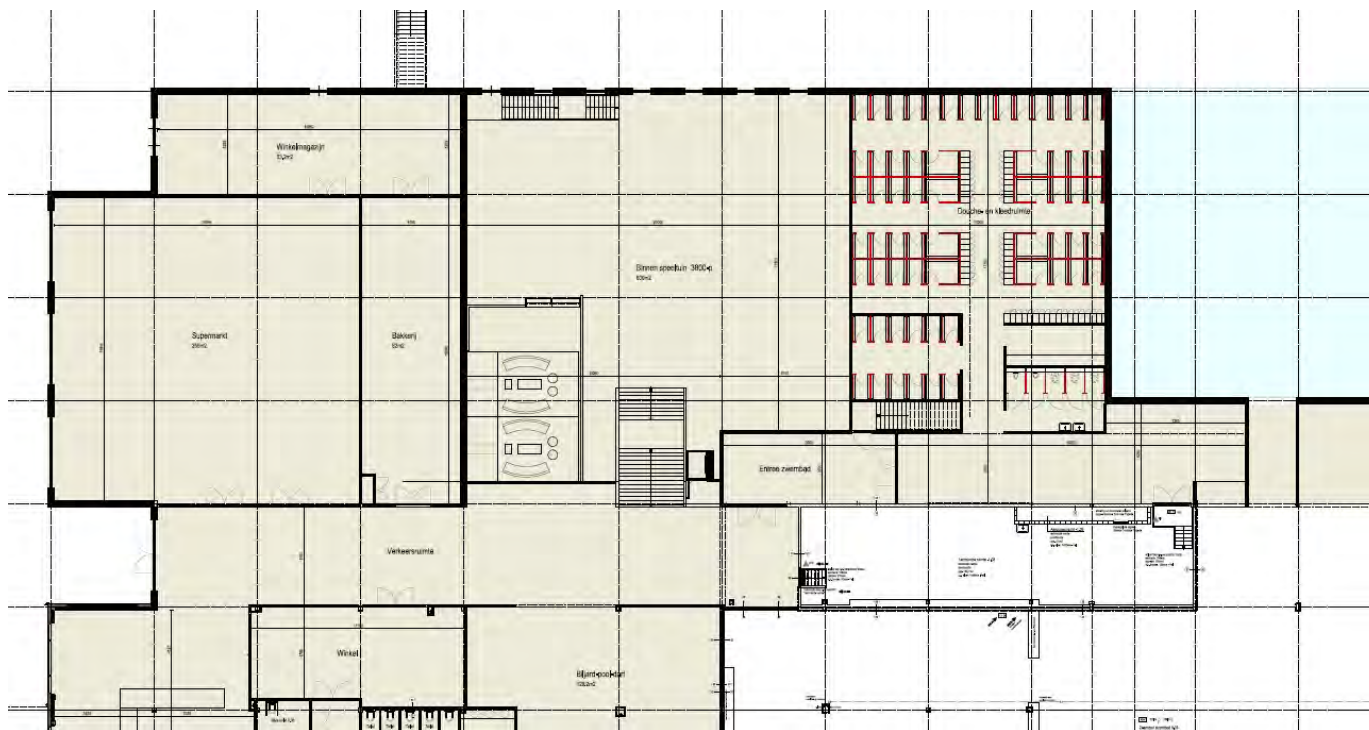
Uitbreiding van centrumgebouw met luchtfoto als ondergrond
